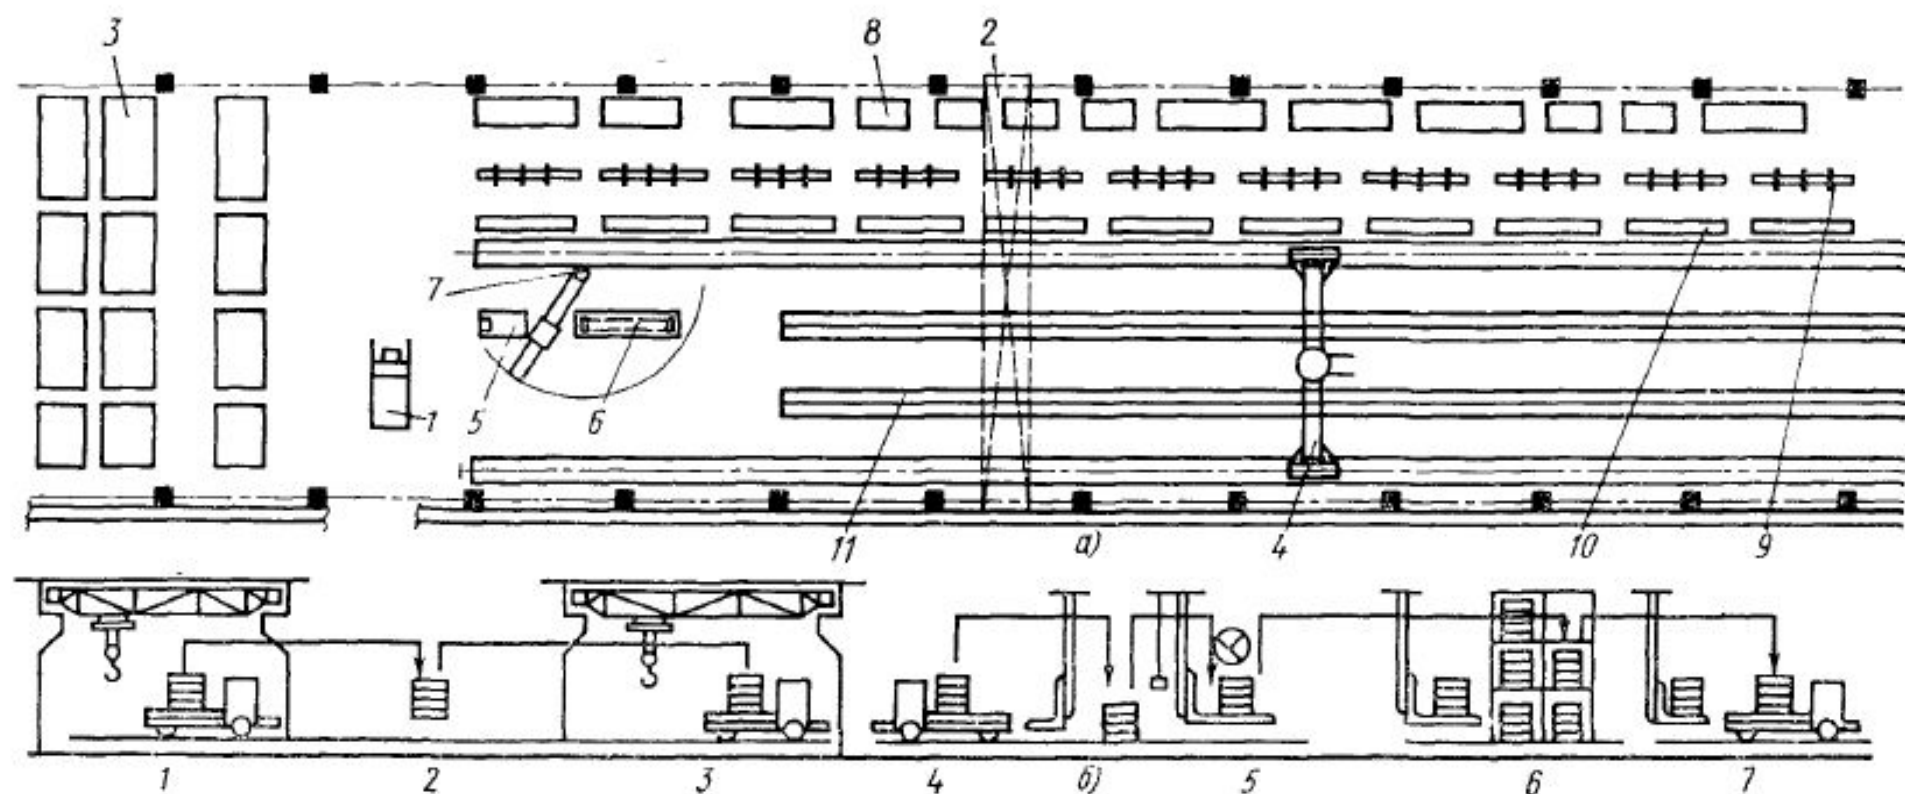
Схема планировки склада готовых деталей с механизацией подъемно-транспортных операций:
